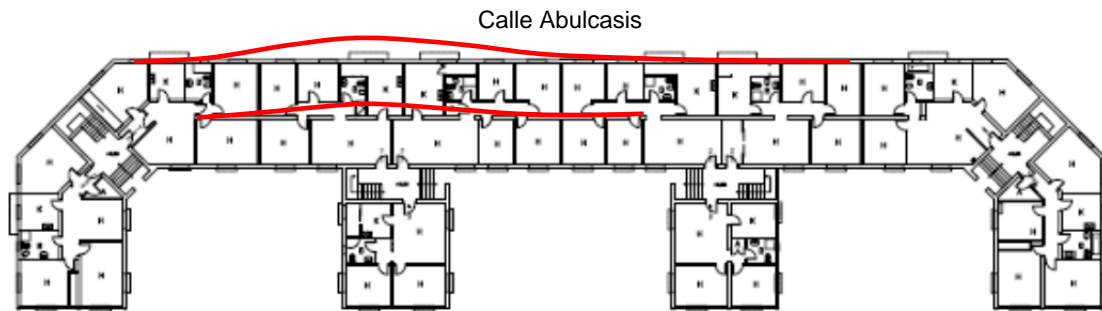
Distribución de las grietas y fisuras en el edificio.
